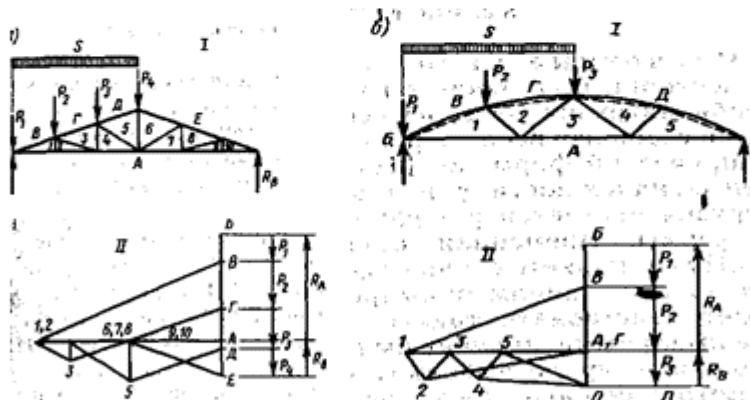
Навантаження і зусилля в стержнях ферм:
